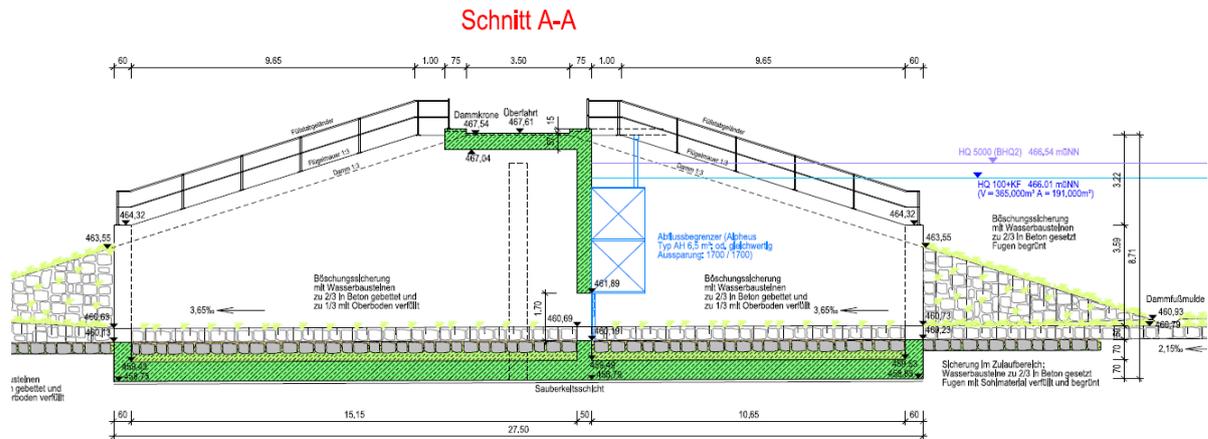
Planausschnitt (113474-24-HW) Querschnitt Dammbauwerk mit Durchlassbauwerk und Drosselorgan
